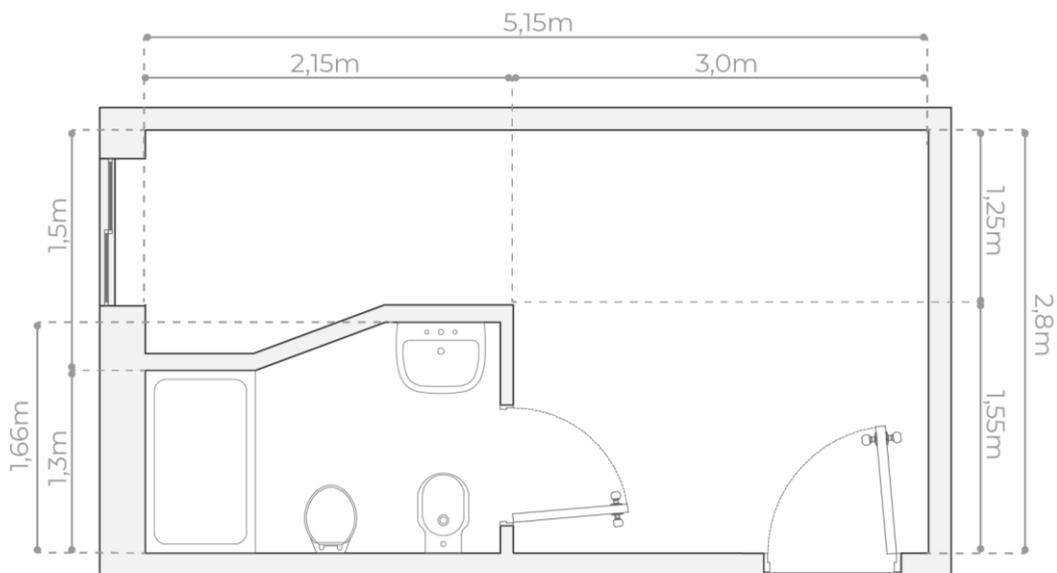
Planta cotas caso de estudio. Escala: 1:50. Fuente: elaboración propia
